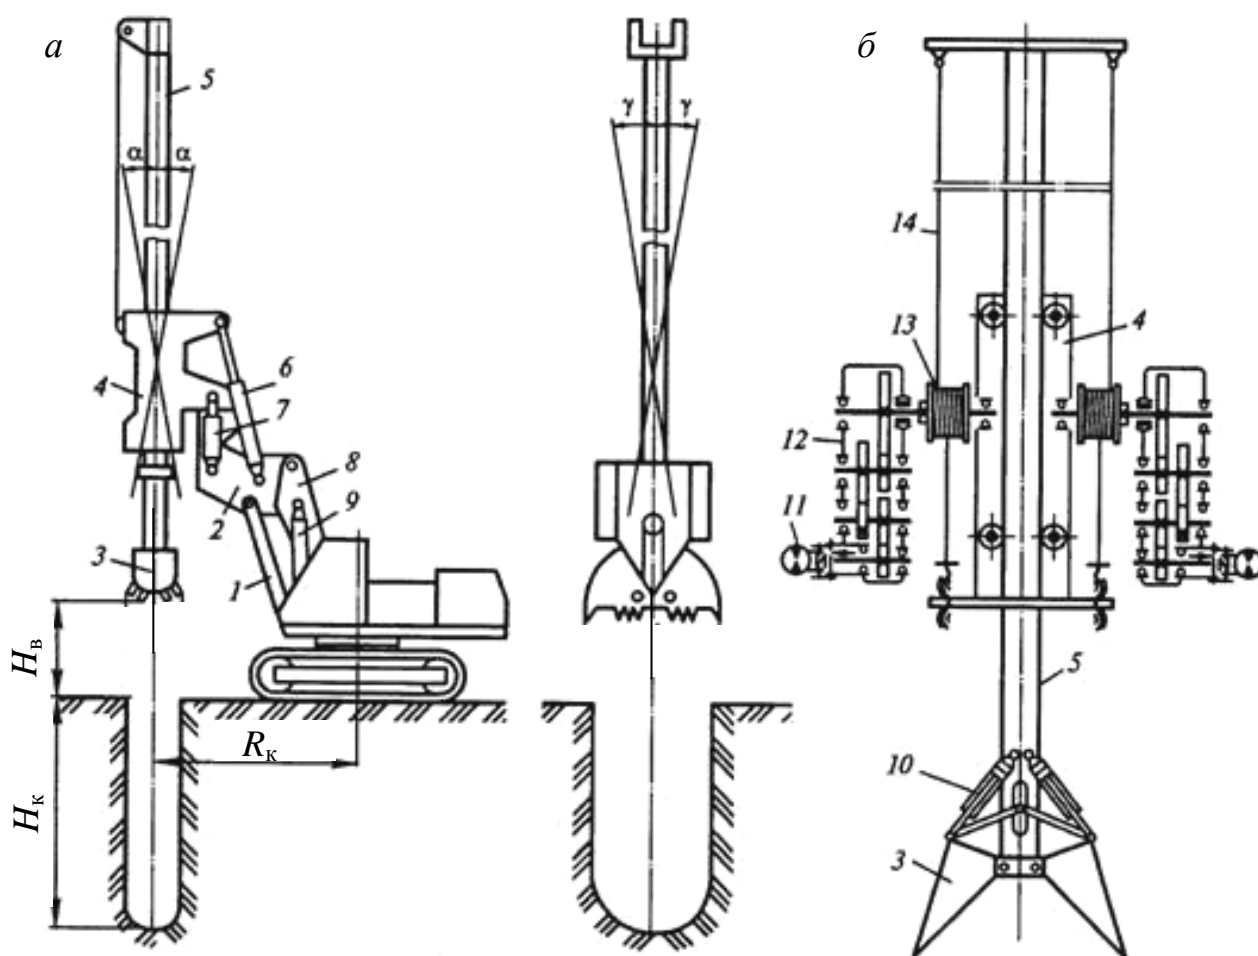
Экскаватор с грейферным оборудованием проведения открытых выработок методом «стена в грунте»: *а* – общий вид; *б* – кинематическая схема перемещения штанги
